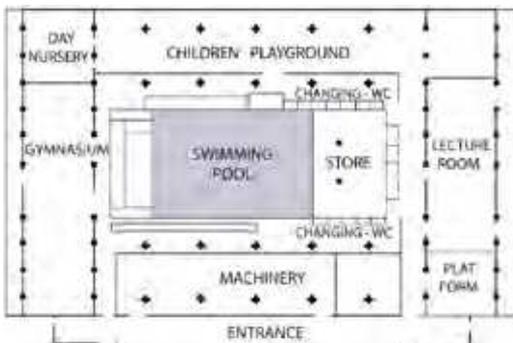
Grundriss des Pioneer Health Center Sir Owen Williams (1935)
